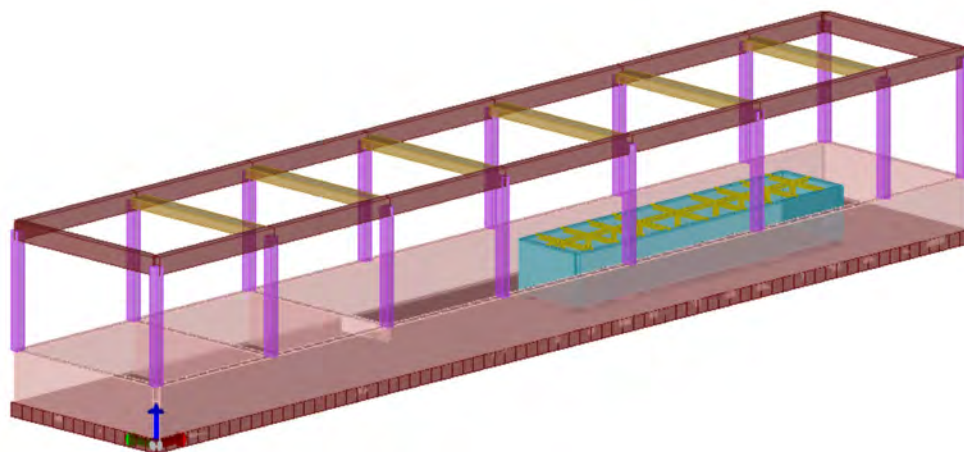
vista estrusa 3: solai, tamponature e piano terra spenti
